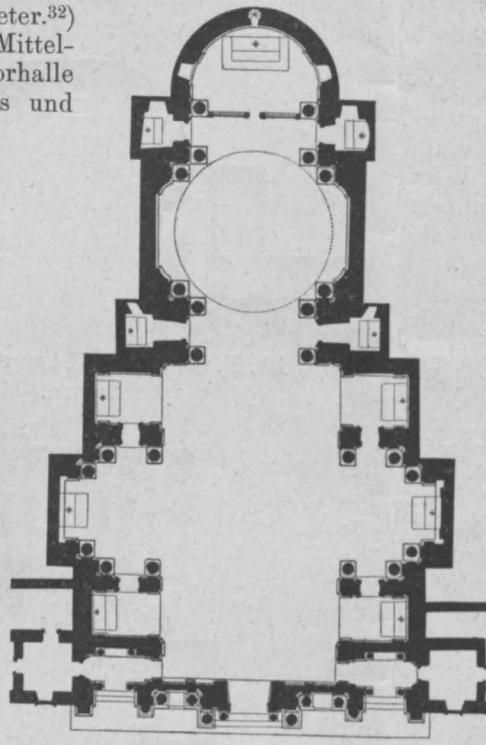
Grundriß von Sta. Maria in Porticu (in Campitelli), nach Sandrart.
